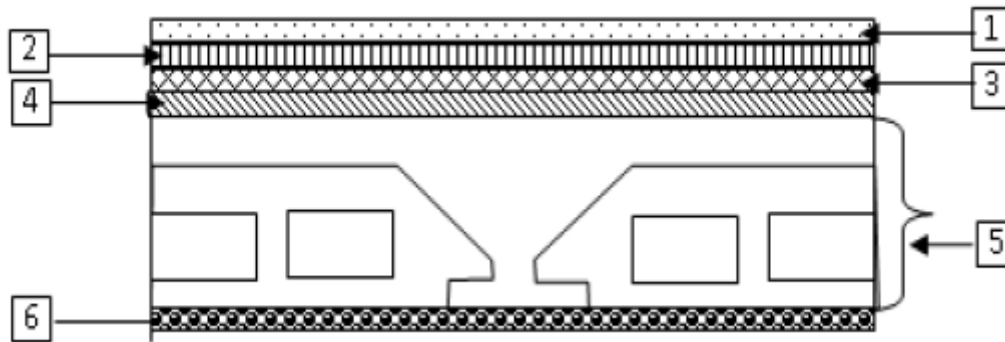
Coupe transversale d'un plancher terrasse inaccessible.
